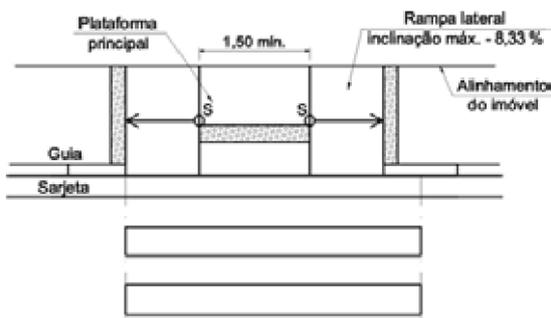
Tipos de rebaixamento de calçadas, conforme a NBR 9050/2004.
